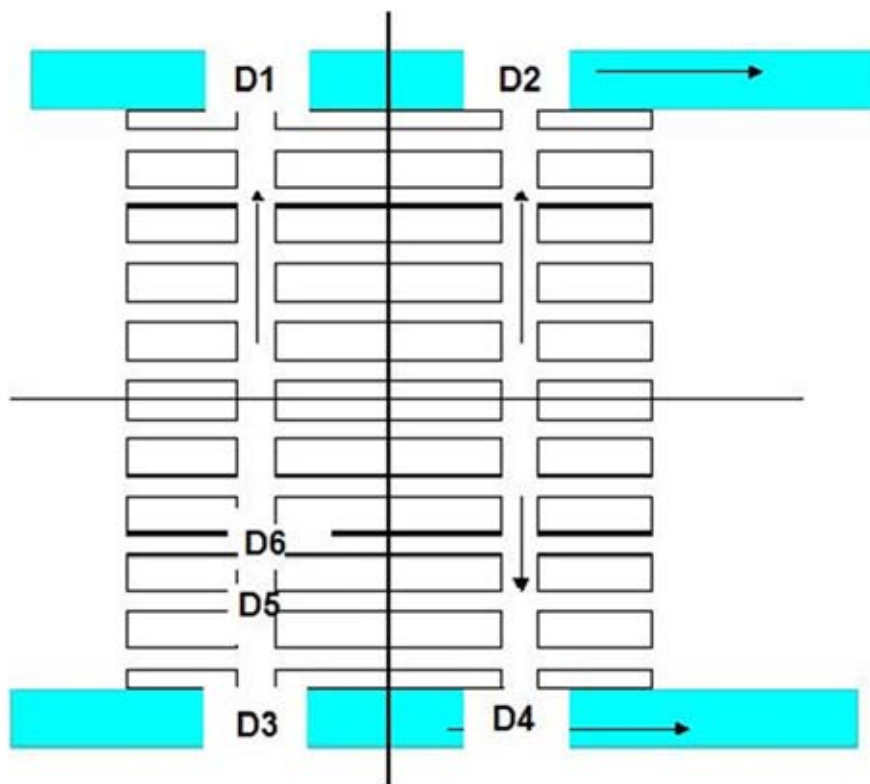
Esquema de la batería de decantadores de la Planta de Tratamiento de Aguas.
